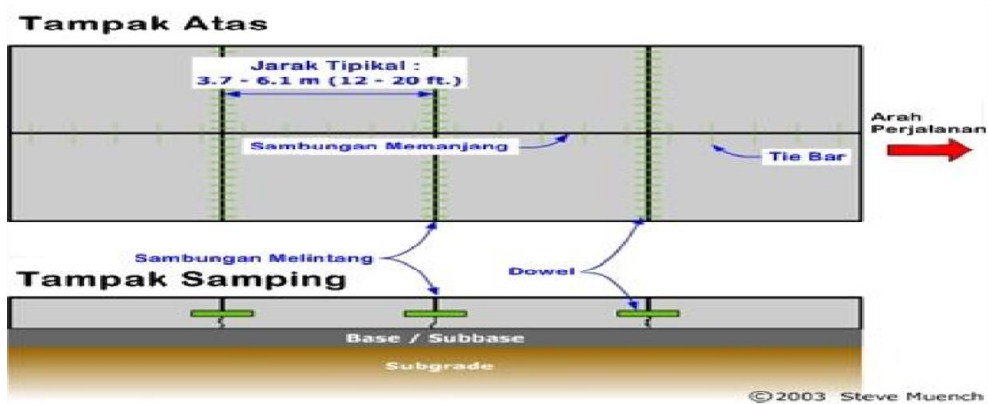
4 Tipikal struktur perkerasan beton semen
